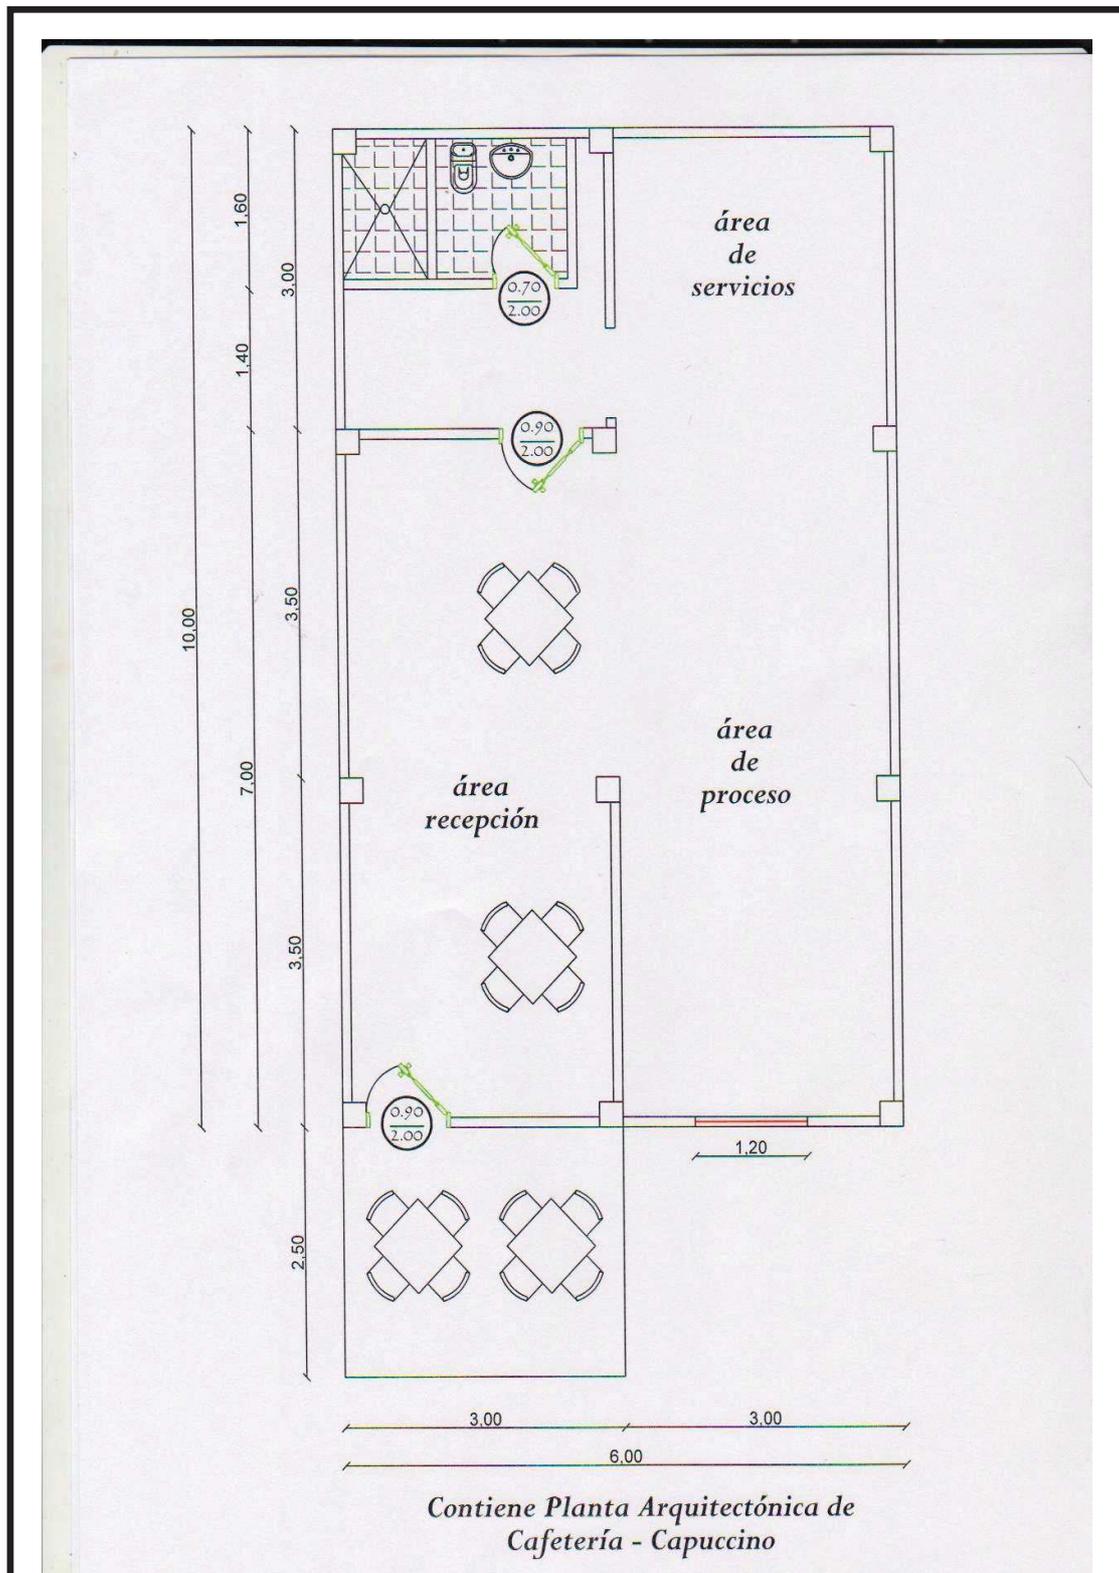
Planta Arquitectónica de la Cafetería Capuccino
